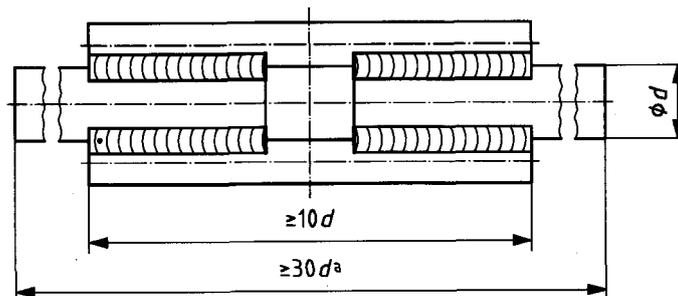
Probe für Zug- und Biegeversuch an einem Stumpfstoß
